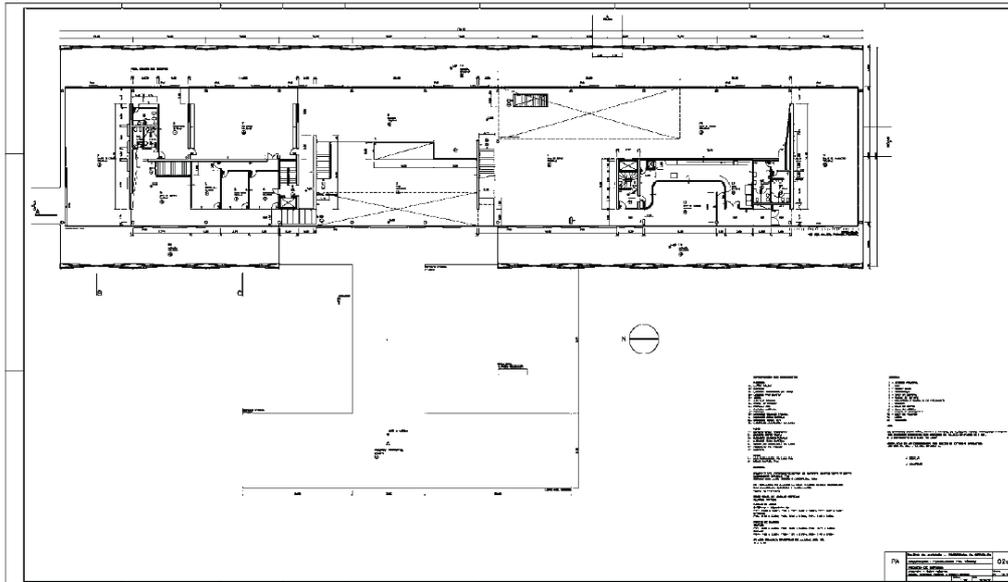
Planta Baixa Original - Térreo do Palácio da Alvorada.
